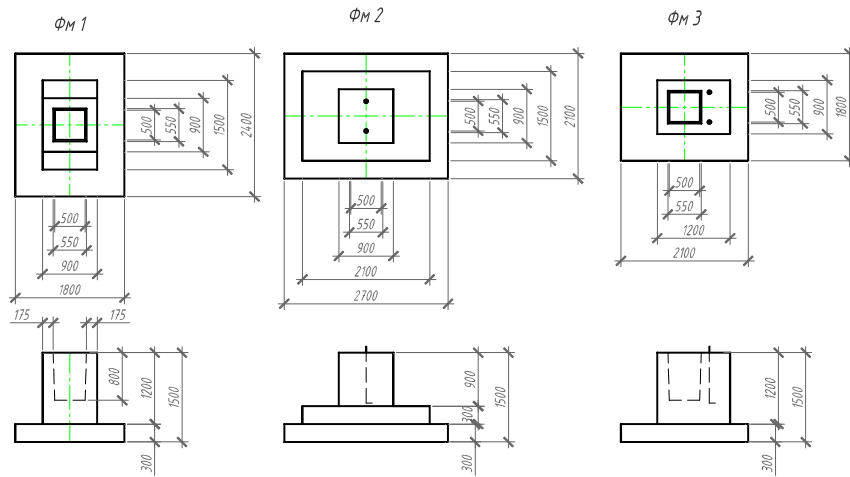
Залізобетонні монолітні фундаменти
